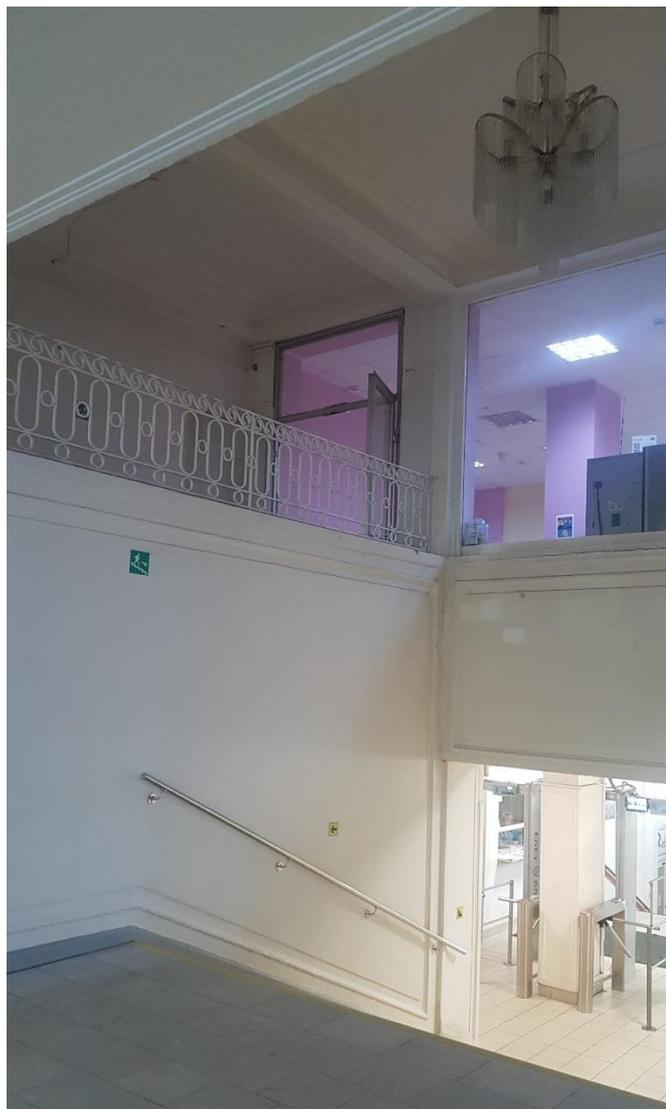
Помещение № 168 второго этажа. Вид на ограждение лестницы.
